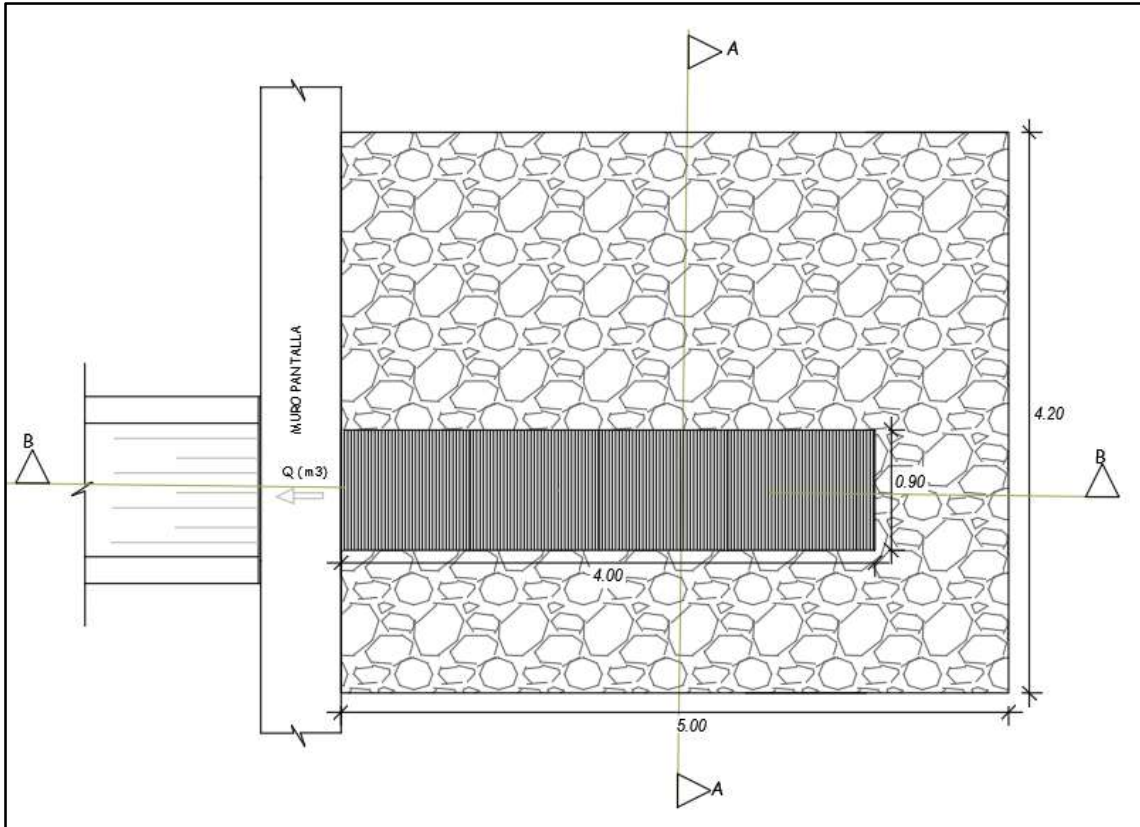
Plano de planta de la bocatoma tirolesa.
